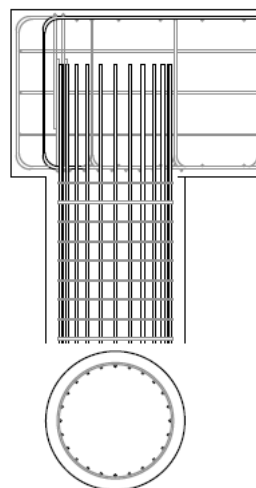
Bewehrungsführung Widerlagerwand
